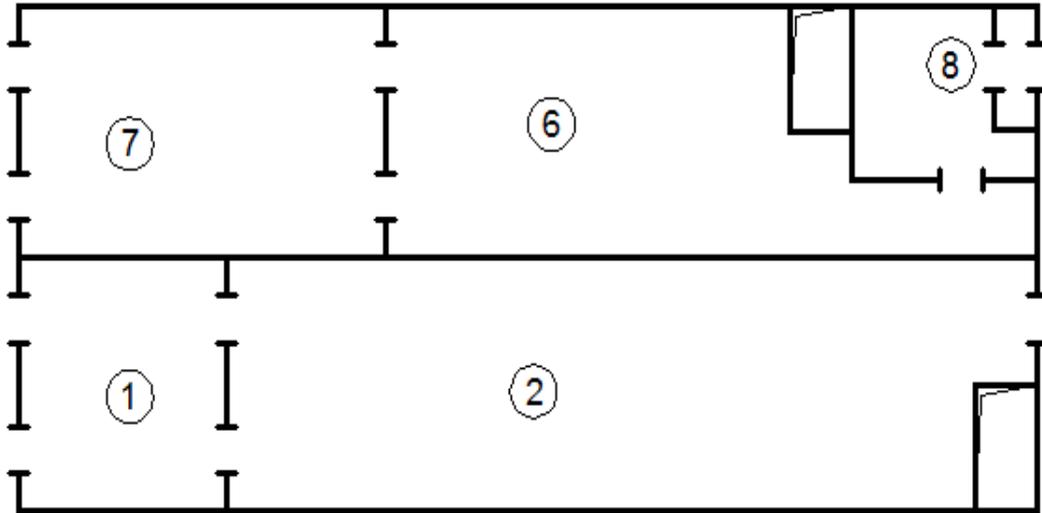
Схематичное расположение отделений заготовительного корпуса завода приборостроения при «Т»-образном блокировании корпусов
